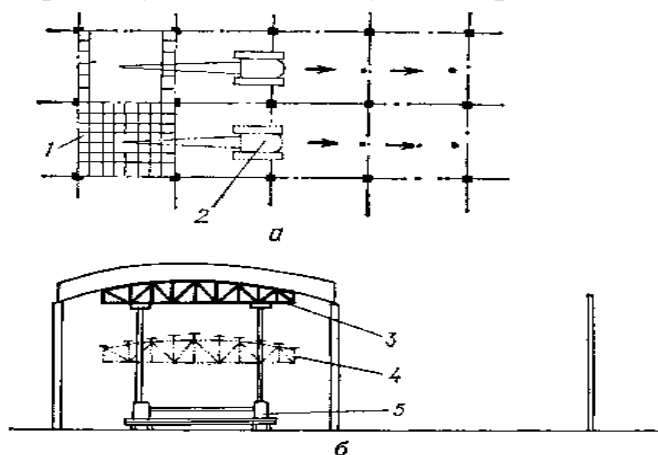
Монтаж оболонок за допомогою інвентарного кондуктора: а – схема монтажу; б – схема підняття; 1 – розрізування оболонки; 2 – монтажний кран; 3 – інвентарний кондуктор; 4 – кондуктор в транспортному положенні; 5 – візок з телескопічними стійками
